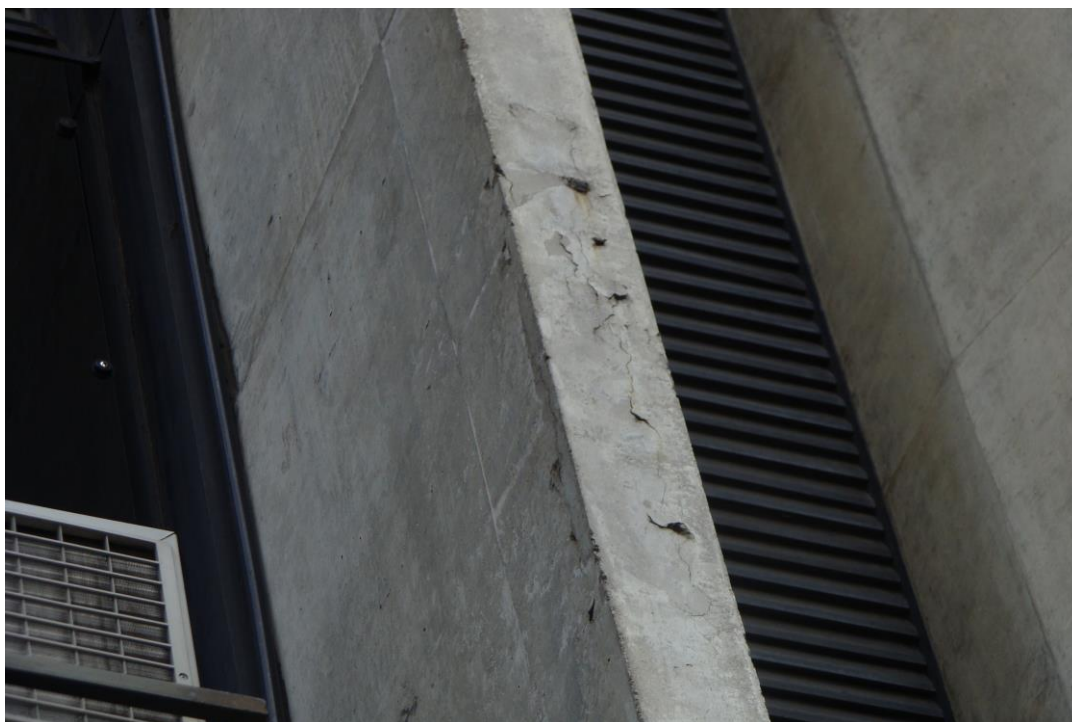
Armadura exposta pilar P12 (4º pavimento) (19/11/2013)
